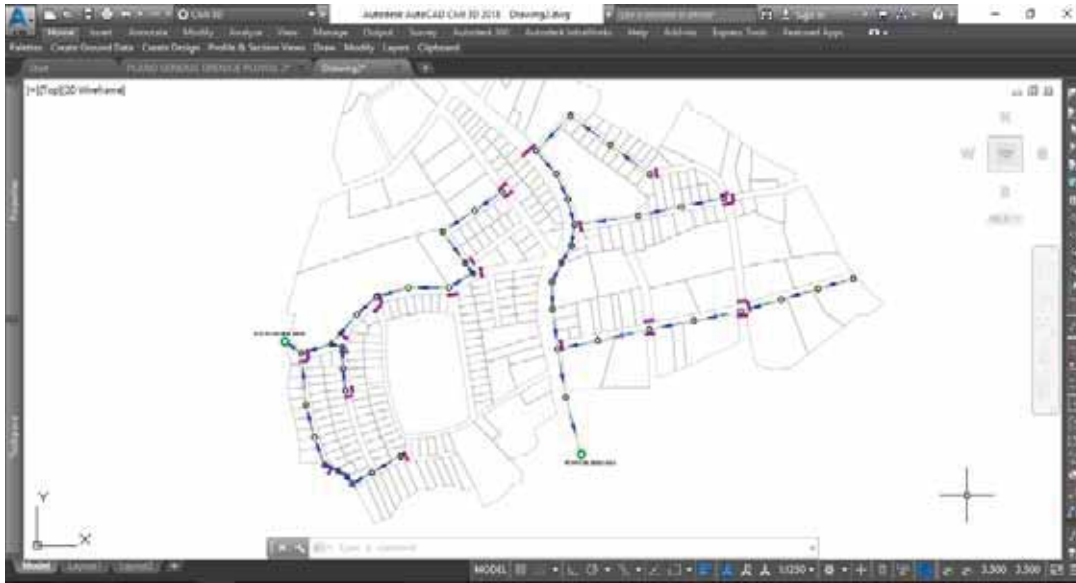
Sistema de Drenaje Pluvial - SewerCAD Connect Edition 10.00.00.4
